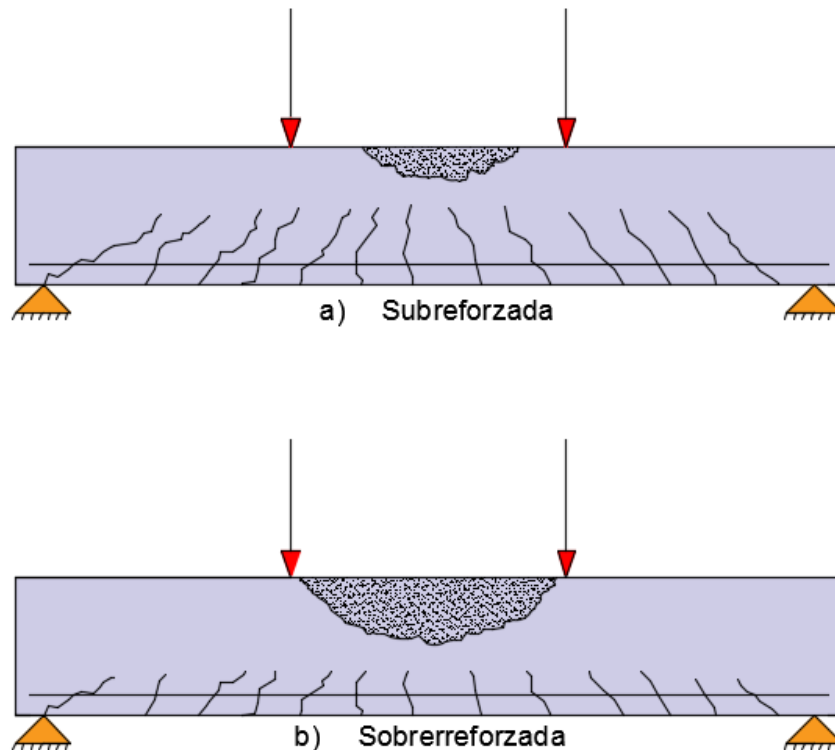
Agrietamiento en la falla de vigas sujetas a flexión
